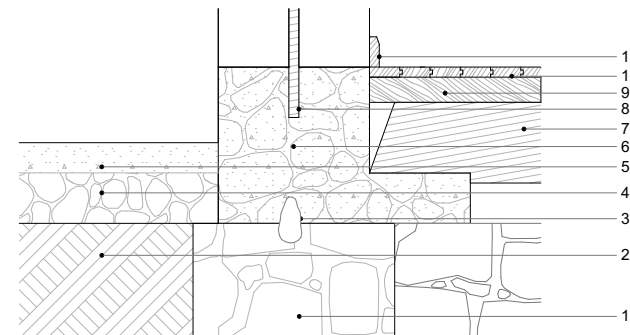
D1 Composición: Cimentación - piso madera - muro adobe
